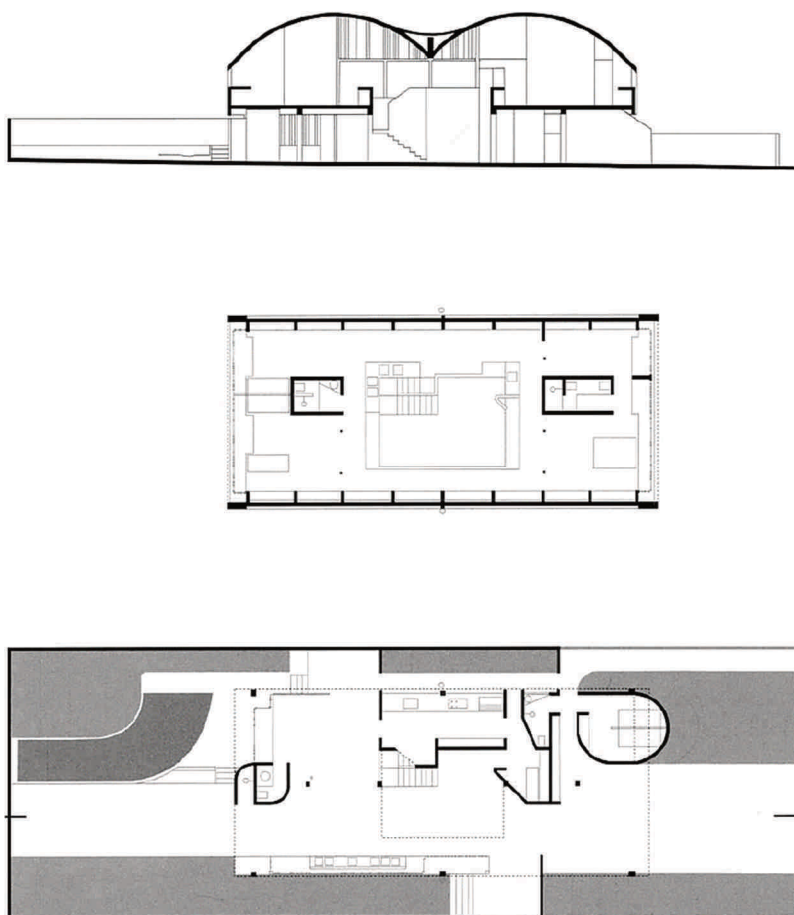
Seção longitudinal, planta do pavimento superior e planta do pavimento térreo. Fonte: GUIMARÃES, 2006.
